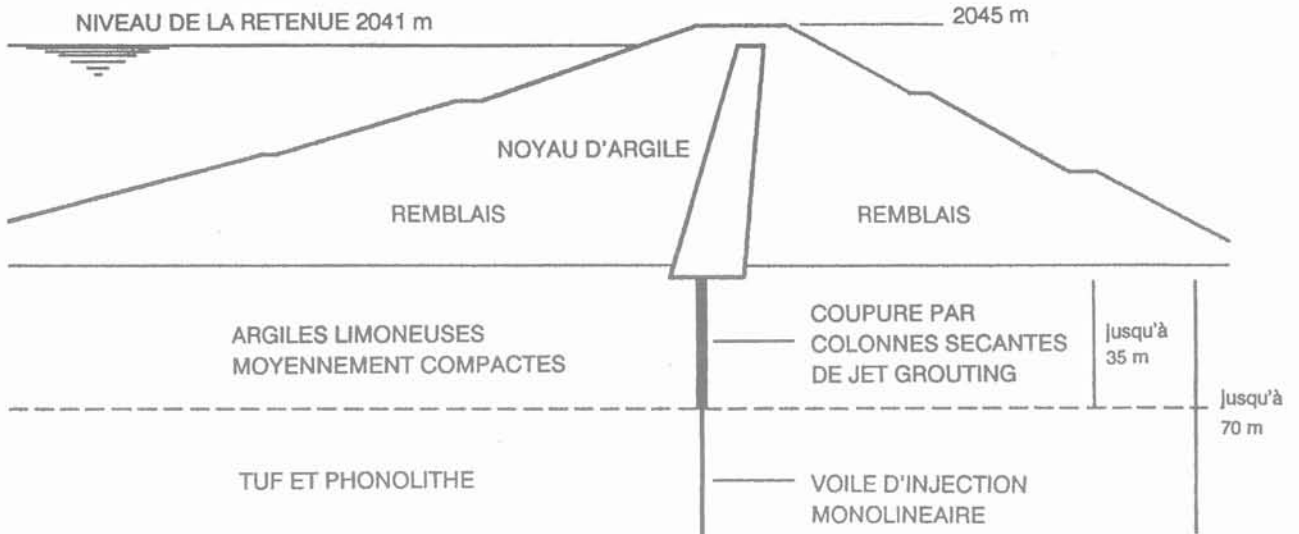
Coupe transversale de la coupure étanche du barrage de Thika.
